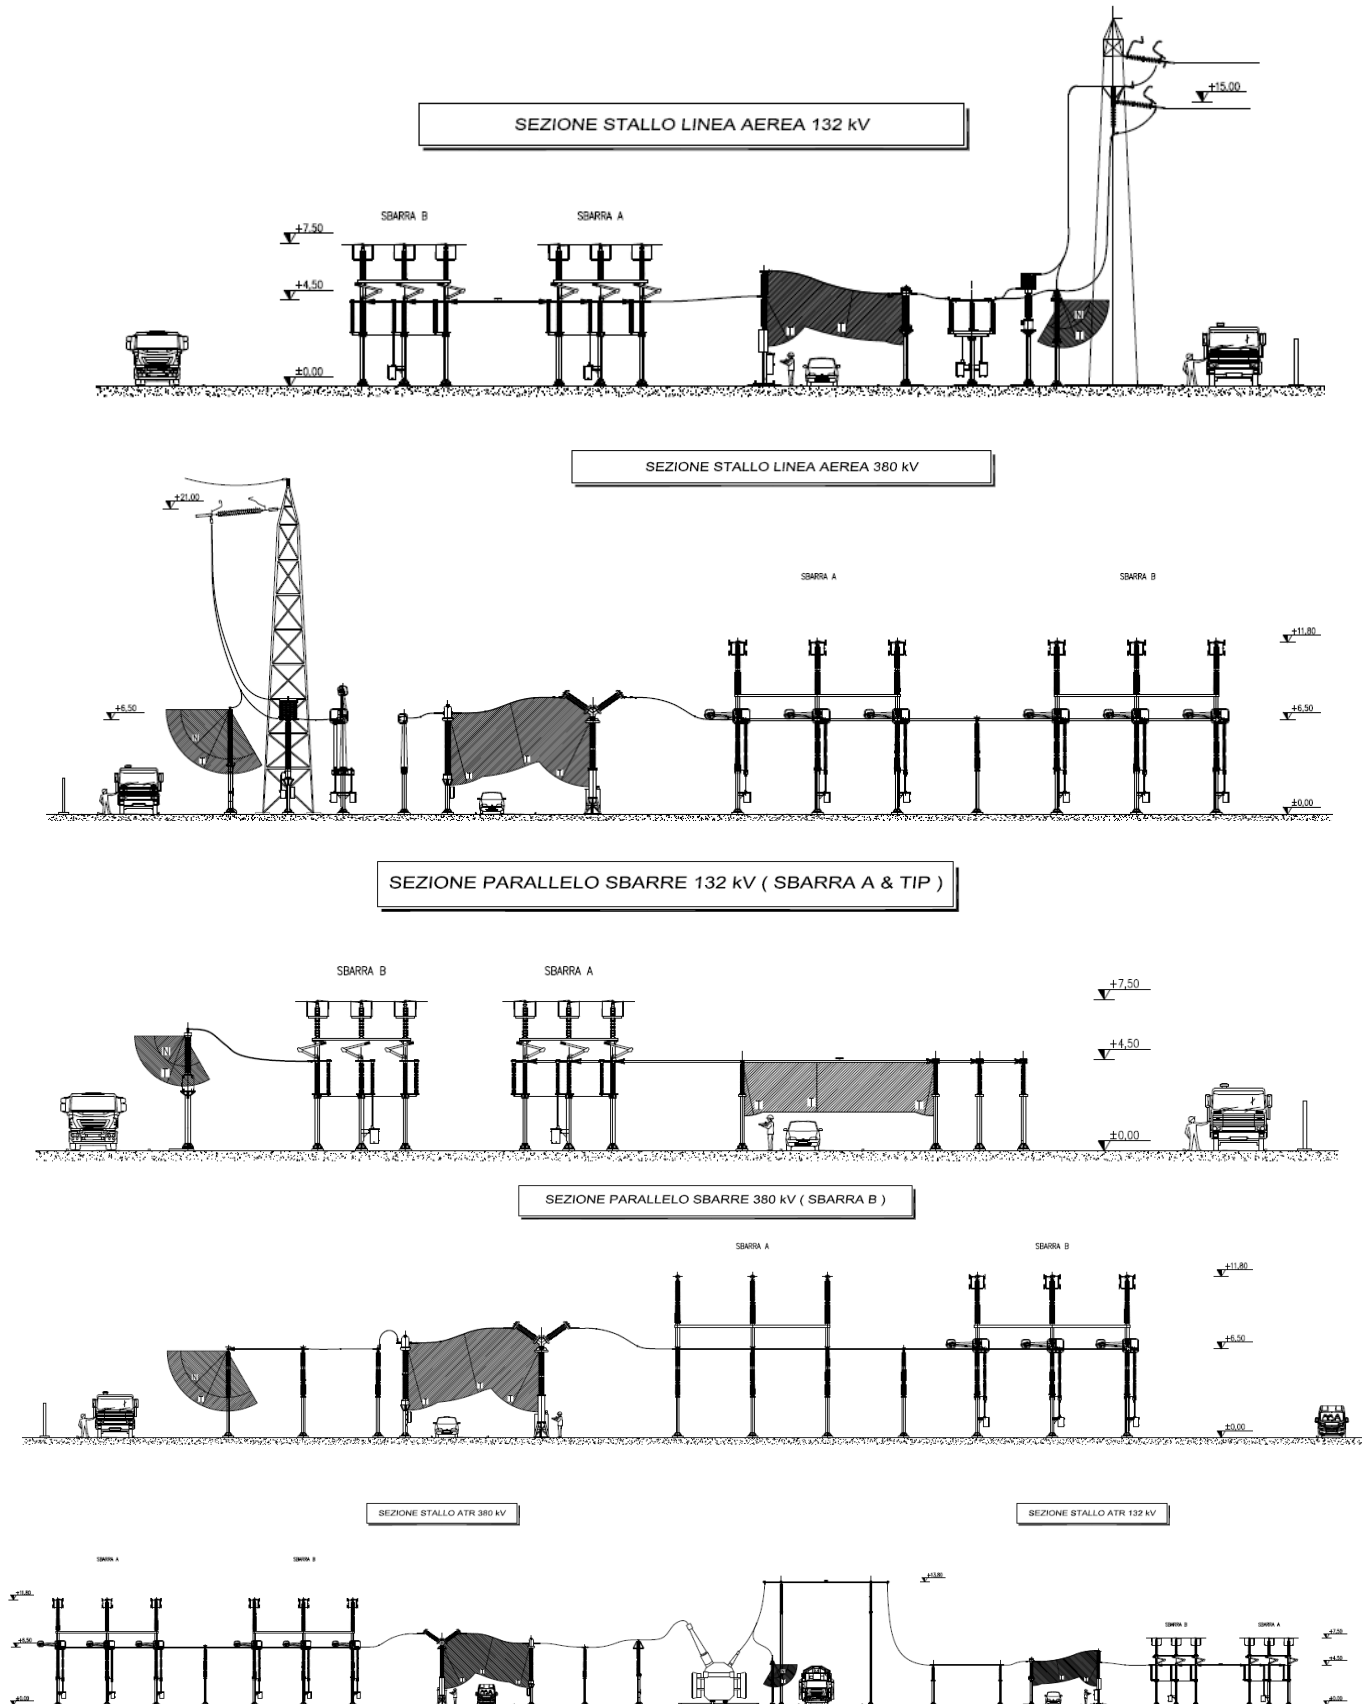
Sezioni degli stalli linea e delle sbarre delle due sezioni 380 e 132 kV della stazione
